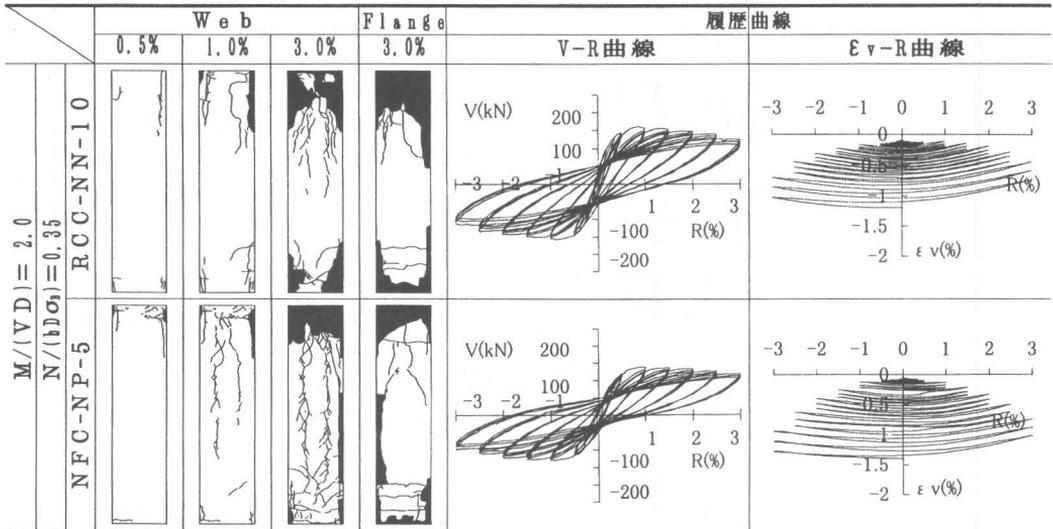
せん断スパン比2の柱試験体のひび割れ図と履歴曲線(実験値)
